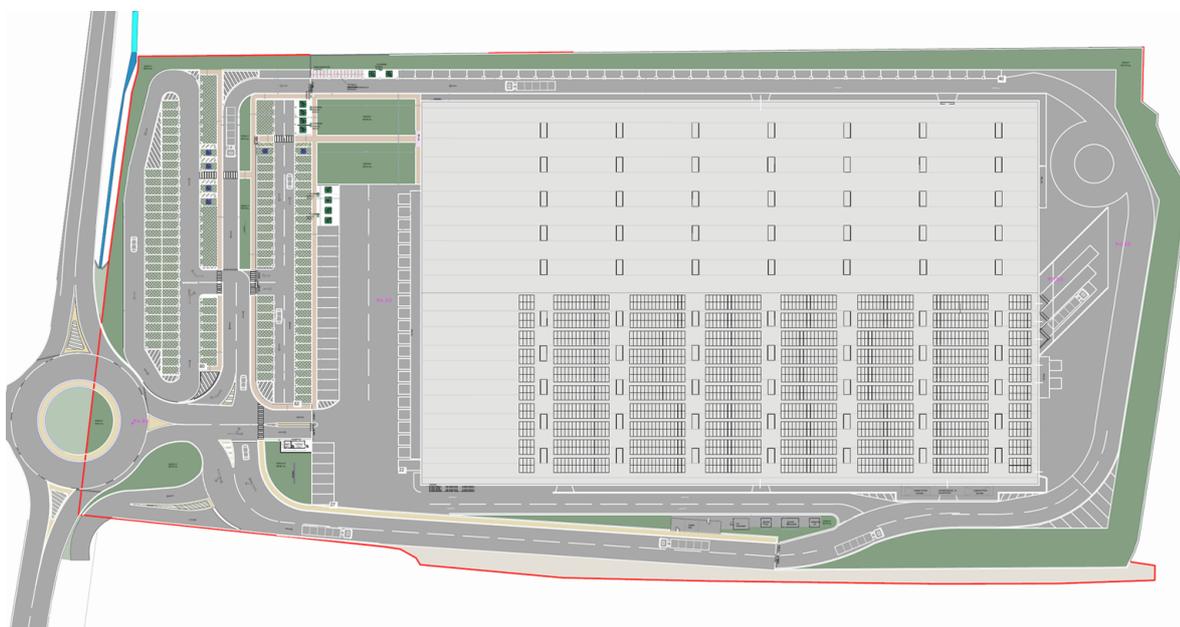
Planimetria Generale piano terra (quota  $\pm 0,00$  m) Stabilimento oggetto di analisi.
